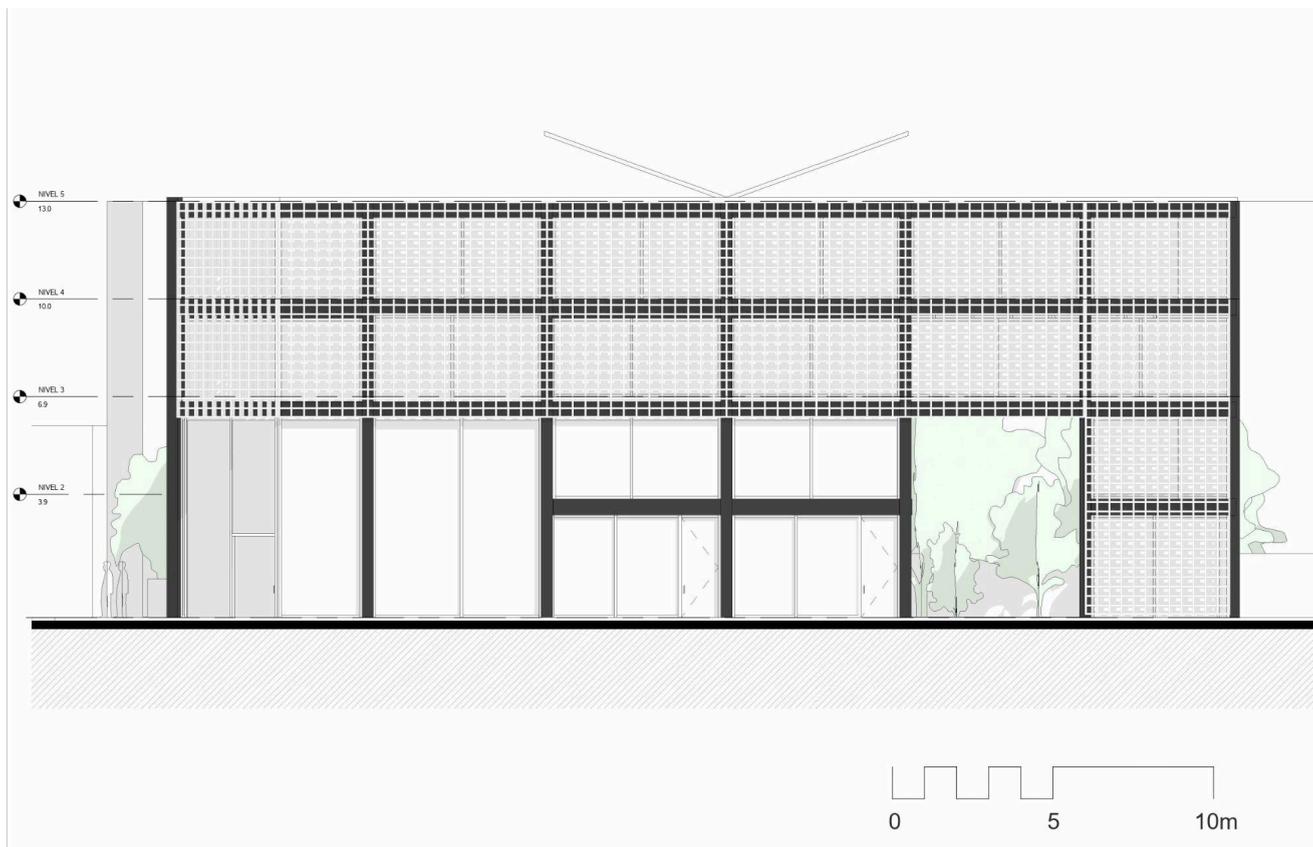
Elevación fachada poniente calle Libertad . Fuente: Elaboración propia.
